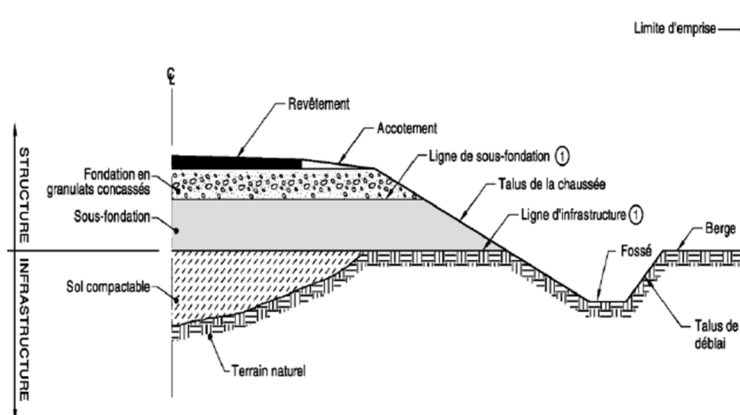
Coupe type chaussée souple (MTQ, 2006)
